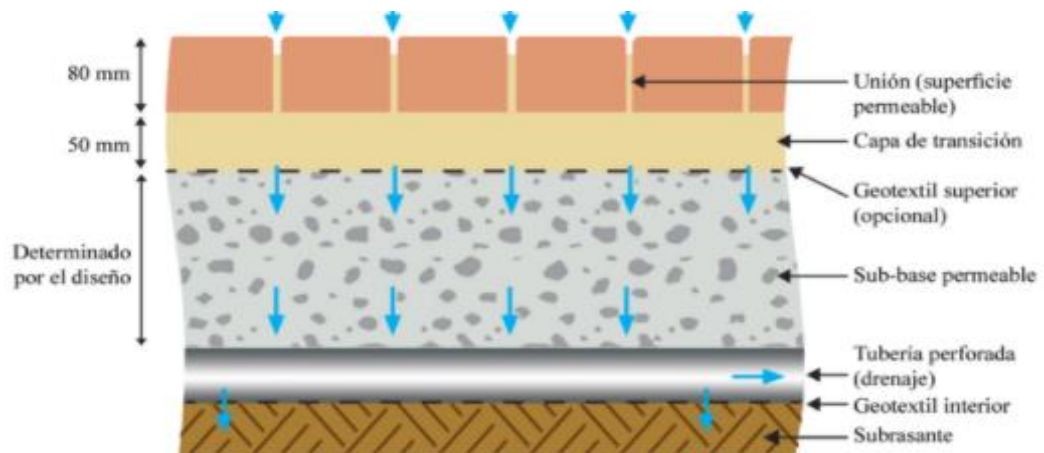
Sistema constructivo del pavimento permeable con pozos de absorción
